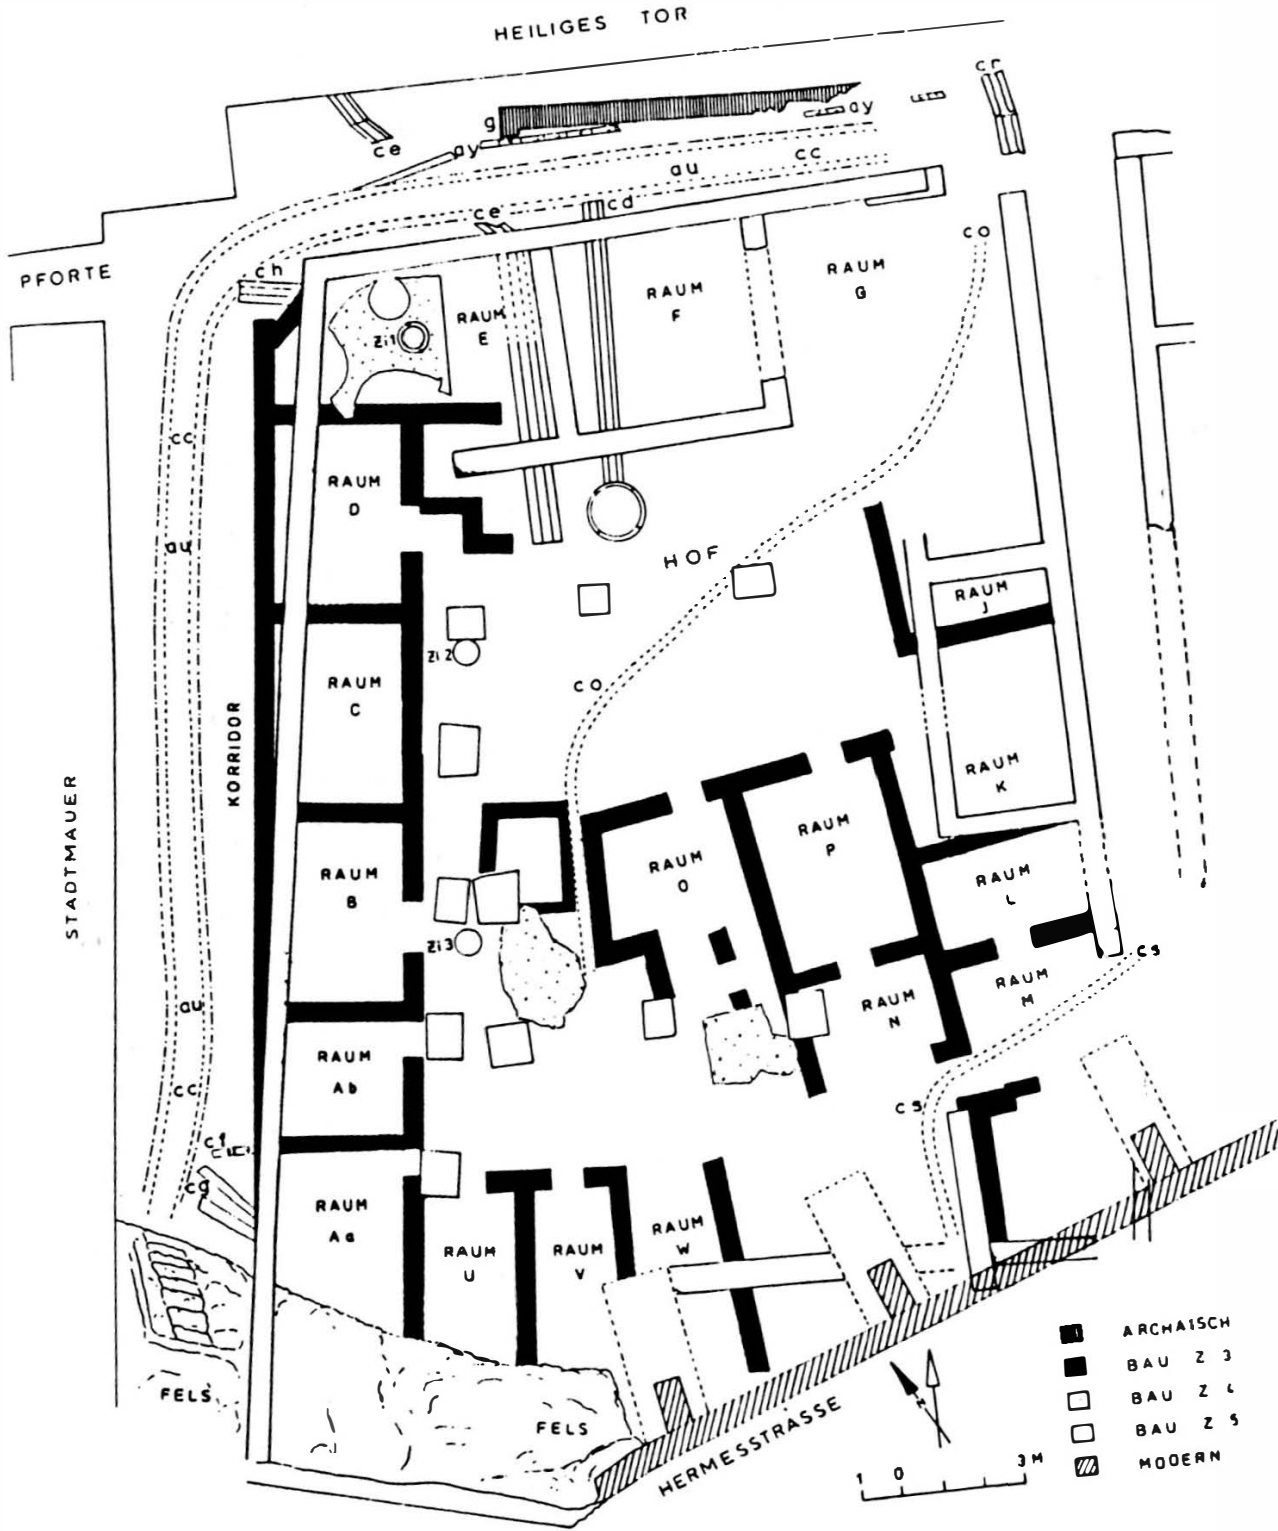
Grundrisse der Bauten Z 3-5 (Phasenplan) (aus: U. Knigge, AA 1980, 258)
